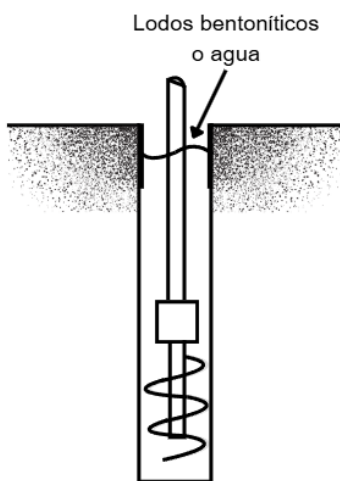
Esquema de excavación para la construcción de pilas o pilotes.
